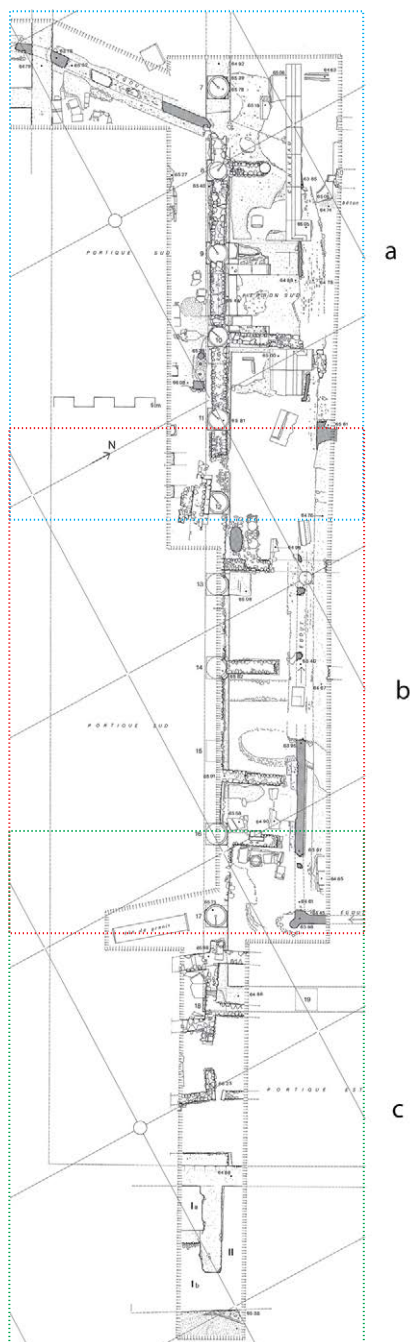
Plan de détail de la colonnade méridionale (G. Hallier).
